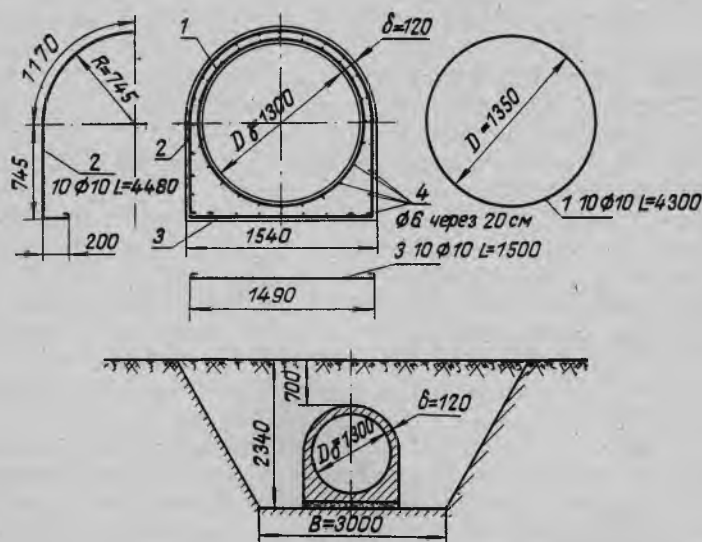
Монолитный железобетонный трубопровод и его укладка в траншее по подготовке из тощего бетона слоем 10 см (размеры в мм).
